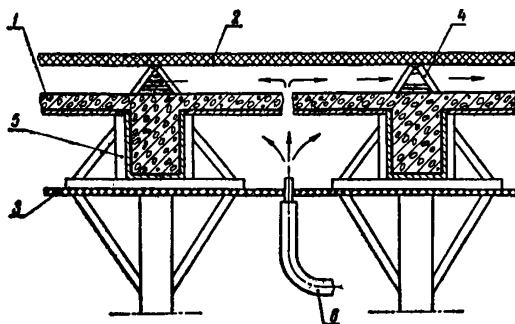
Схема устройства опалубки при обогреве паром или воздухом ребристого перекрытия
